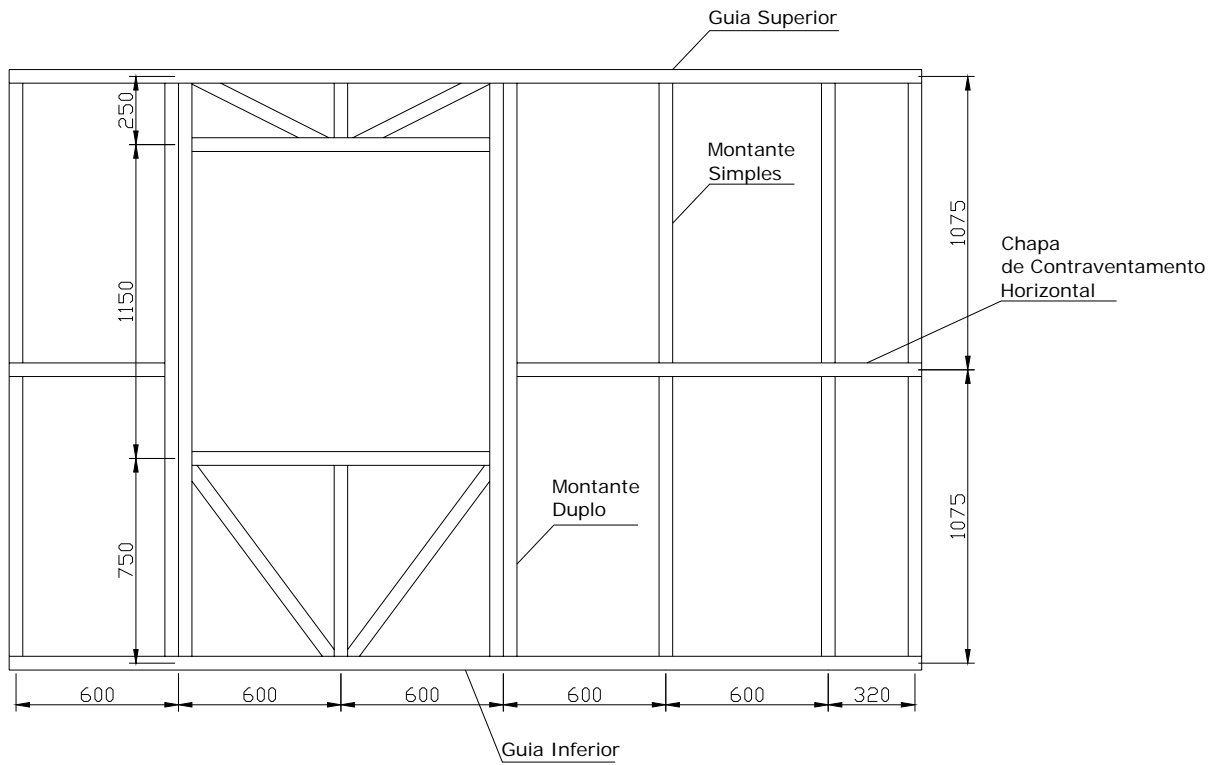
Parede estrutural “Steel-Frame” com abertura de janela
